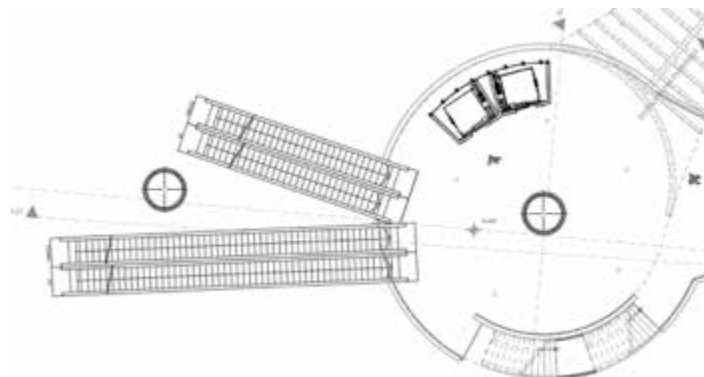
Plaza de acceso 1, planta 1 (+5.45m). (2017)
